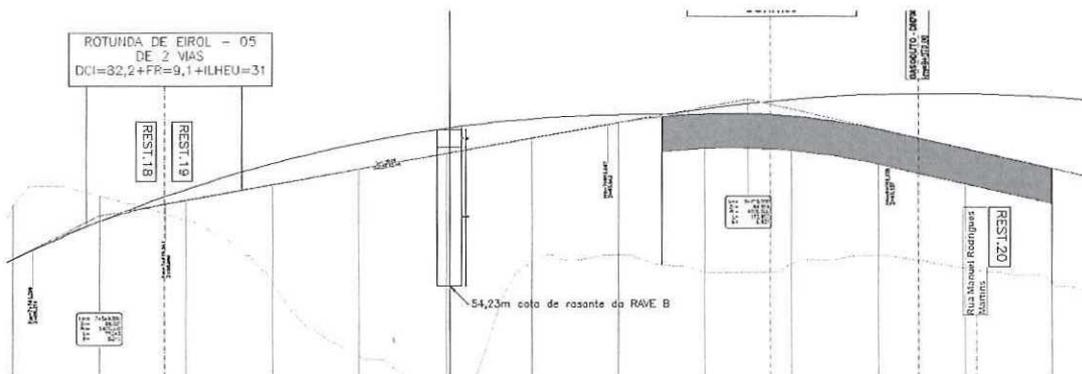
SOLUÇÃO B DO TRAÇADO DA RAVE – PERFIL LONGITUDINAL
